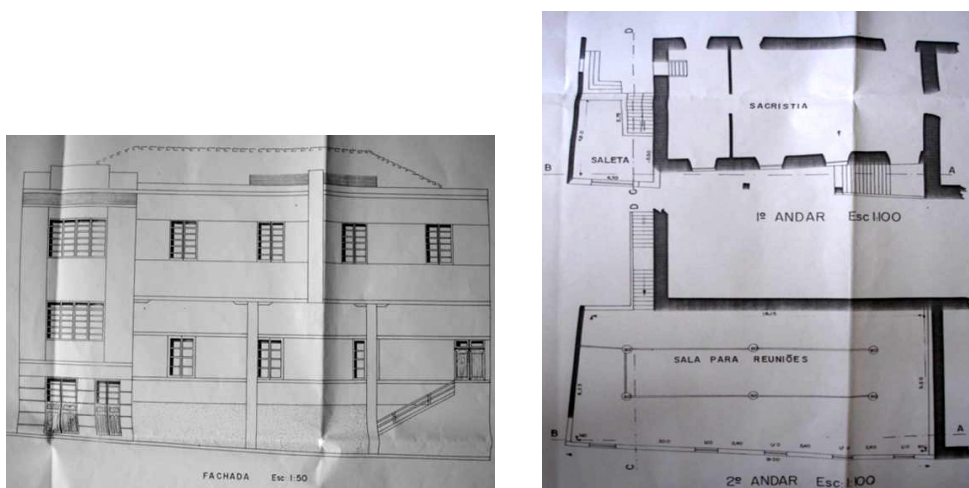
Conjunto de plantas- construção sobre a sacristia, junto a Arcipreste Paiva.
